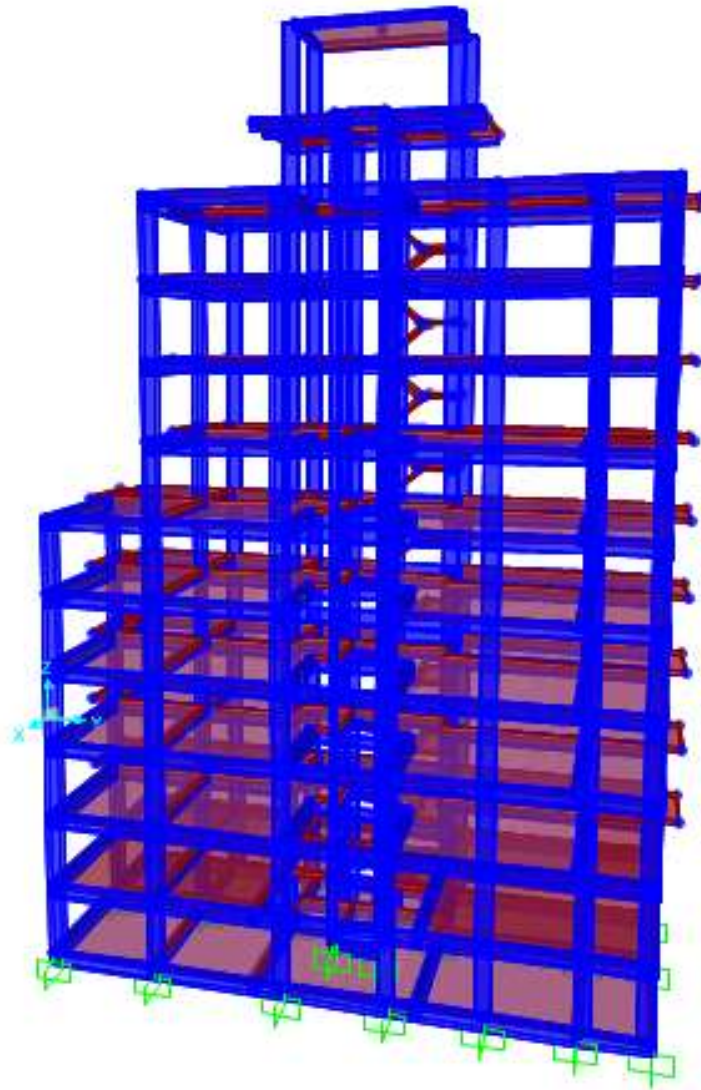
Modelado de la estructura del edificio en SAP2000
